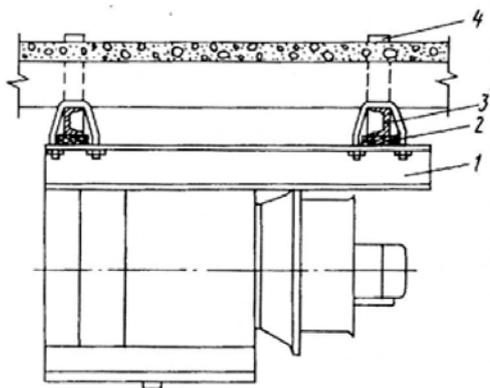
Крепление подвешеного воздухоохладителя к бетонным несущим конструкциям:
